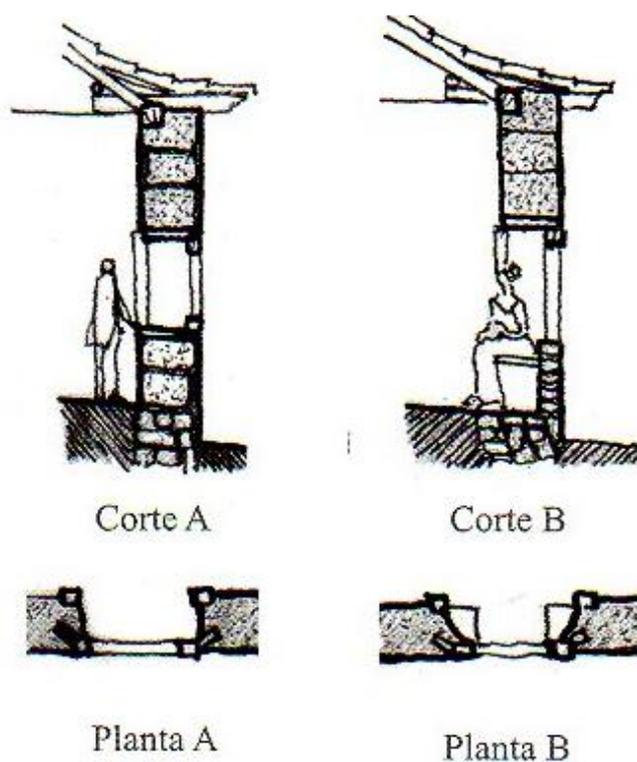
Exemplo dos vãos em parede de taipa de pilão.
